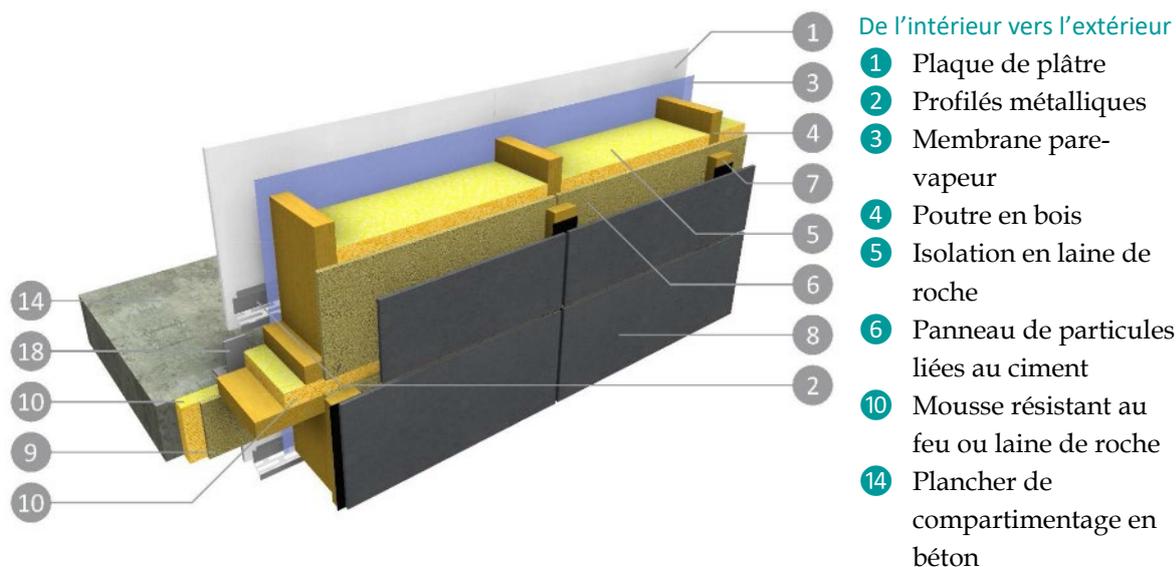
Configurations d'éléments de façade en bois E 60 et leurs liaisons au plancher de compartimentage en béton (Group ETEX).
